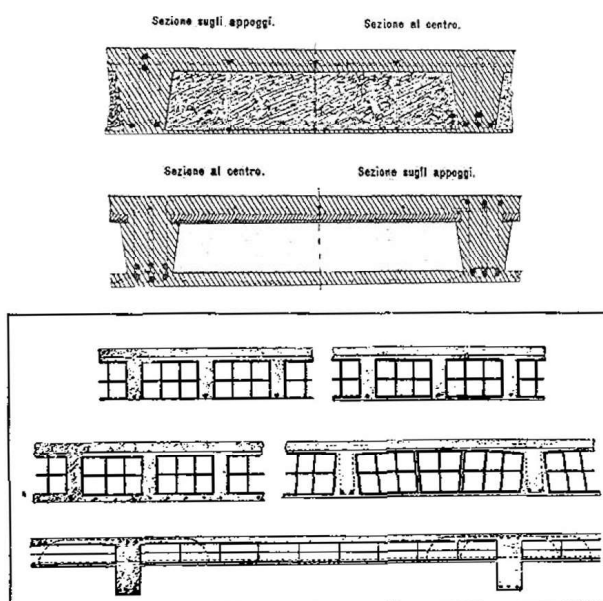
Système de plancher en béton "Ghilardi" [22]
